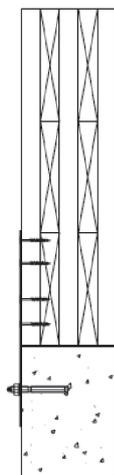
Assemblage métal-bois par plats métalliques sur support béton
